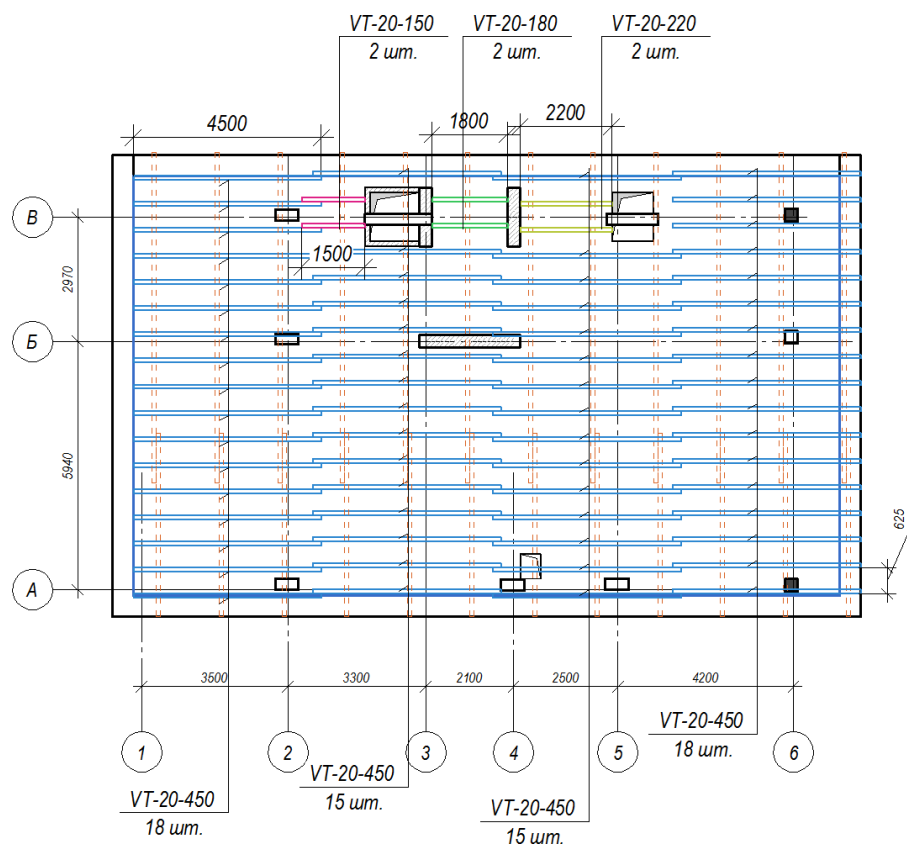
Схема розкладання елементів опалубки на рівні балок верхнього ярусу на другій захватці
